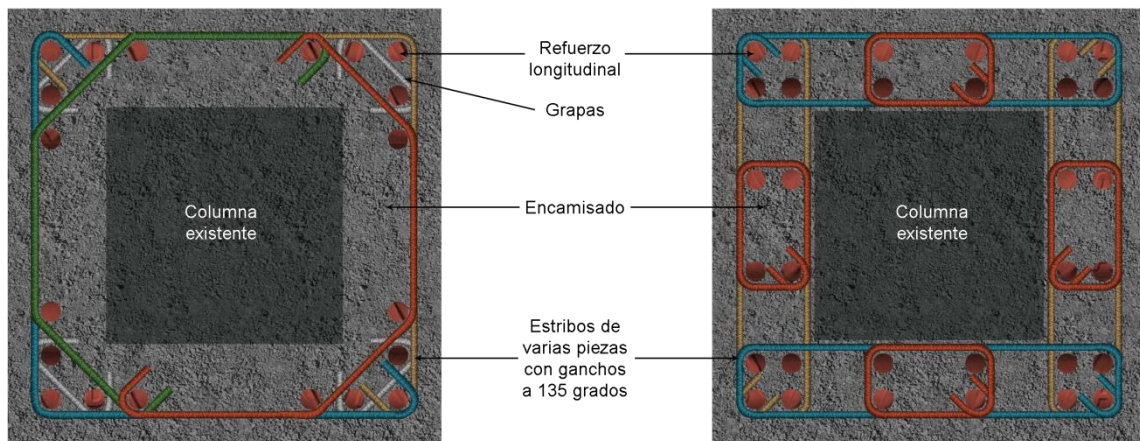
Posibles configuraciones de acero transversal en columnas encamisadas: a) estribos de varias piezas; b) estribos sobrepuestos
